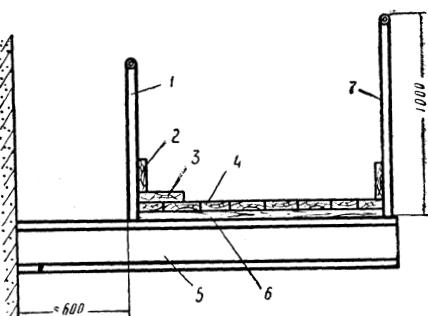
Галерея сцены в разрезе: 1 — задний поручень; 2 — прибортова доска; 3 — усиливающая доска; 4 — настил; 5 — консольная балка; 6 — деревянная прокладка; 7 — передний поручень.
